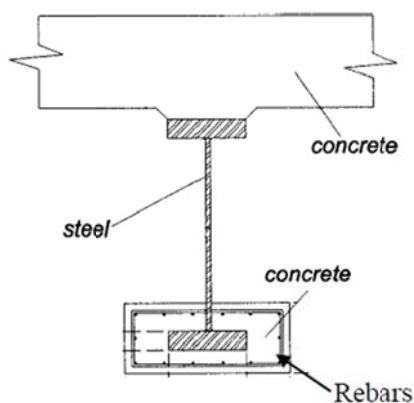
Viga Mista Protendida com sistema Preflex. Tradução: *Rebars* (vergalhões); *Steel* (Aço) (DENG, 2012)
